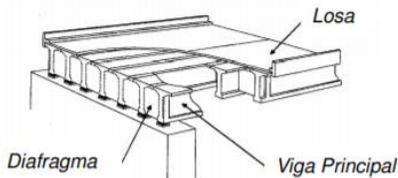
Sistema de viga T. Fuente: MOPT, (2007)
